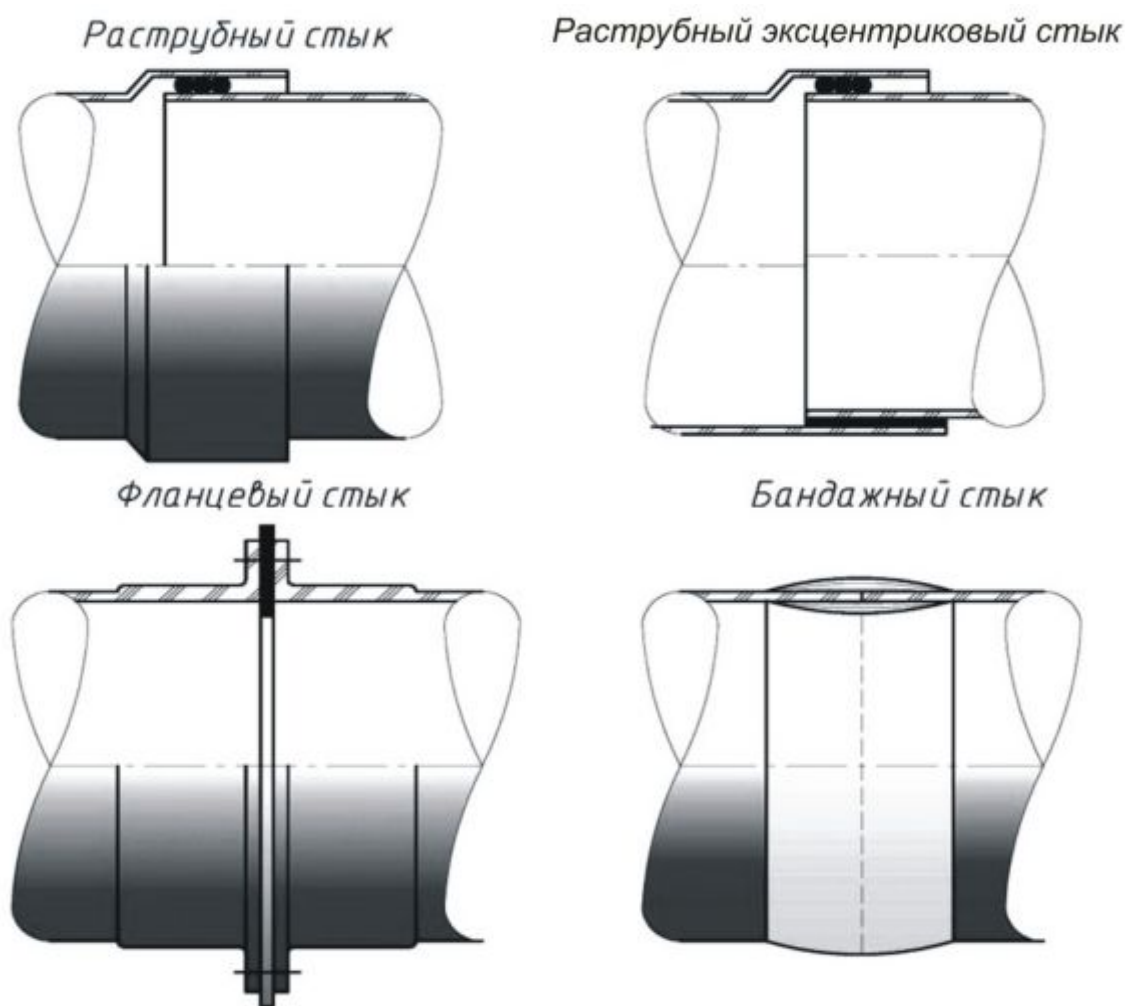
Основные схемы соединений царг газопроводов.
